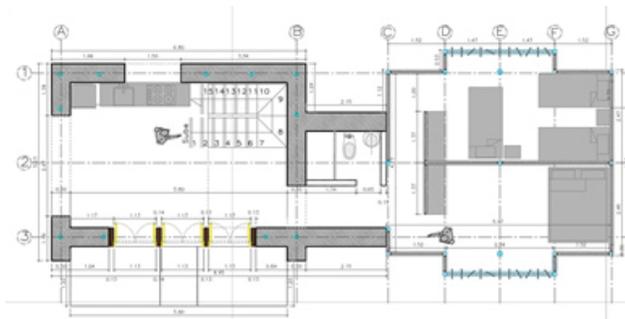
Planta arquitectónica 1er módulo y 2do, vivienda modular sostenible
